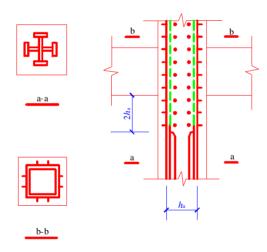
型钢混凝土柱与钢结构柱连接构造
